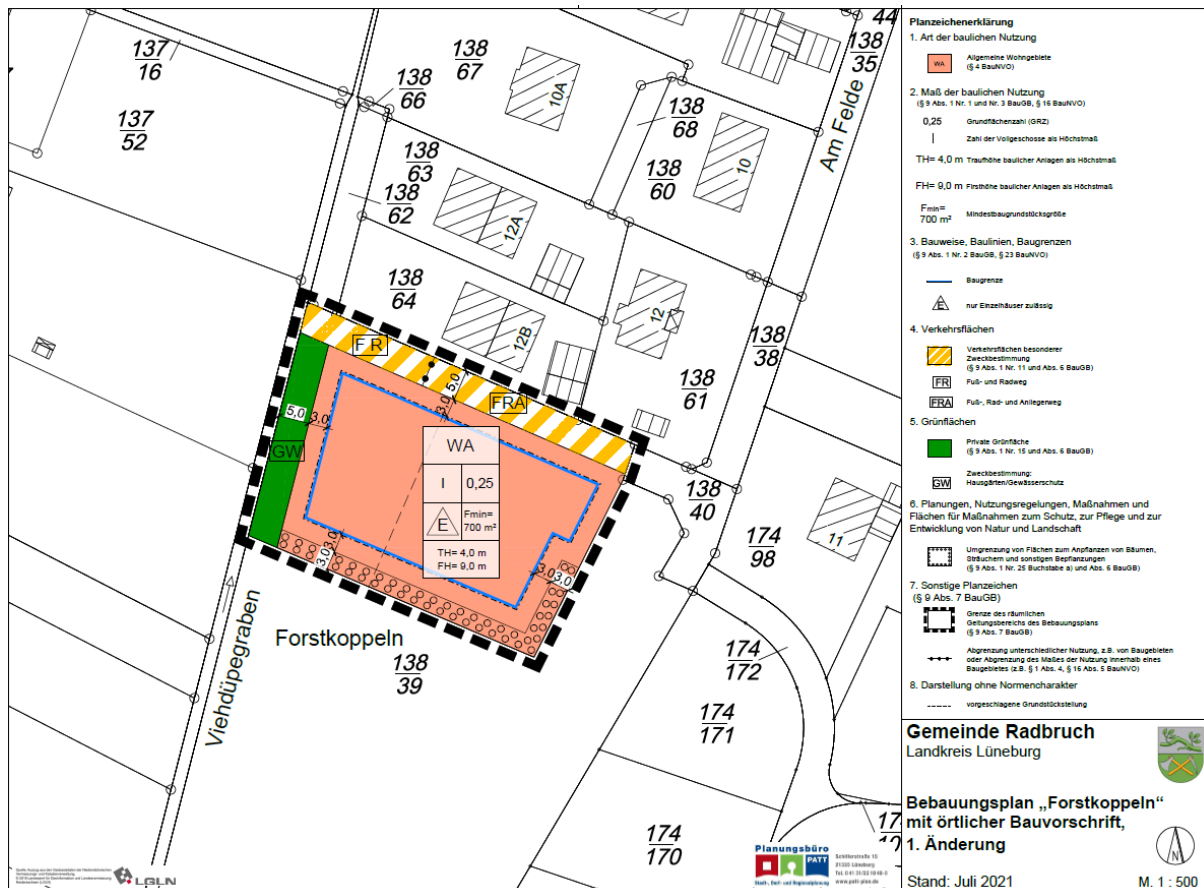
Bebauungsplan „Forstkoppeln“, 1. Änderung, Stand: Entwurf, Quelle: Planungsbüro Patt
